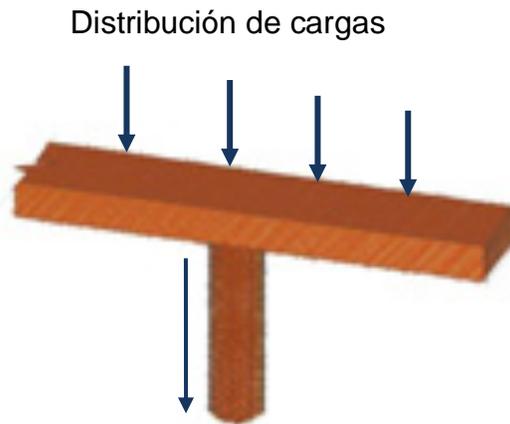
Detalle de poste-dintel. Fuente: Grupo de trabajo.
